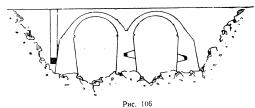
, 105 и 106. Разрушаване на железобетонни и каменни мостове
